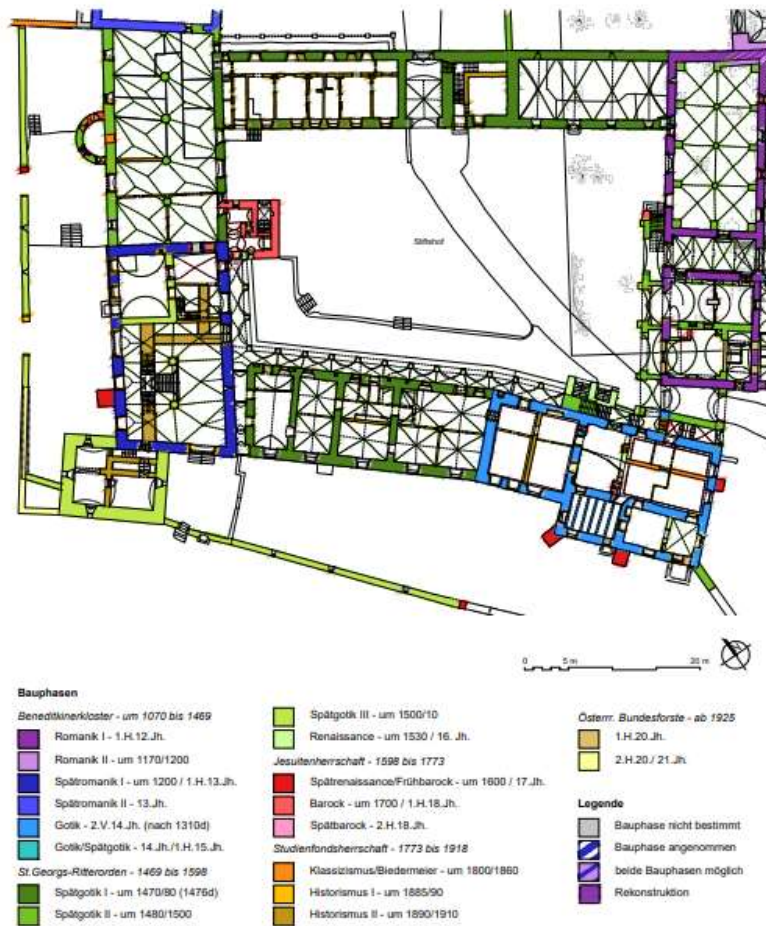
Baualtersplan der den Stiftshof umschließenden Bauatrakte, Grundriss des Erdgeschoßes. (© Wolfgang/Fries/Kuttig, Plangrundlage: EKG Baukultur, Wien)
